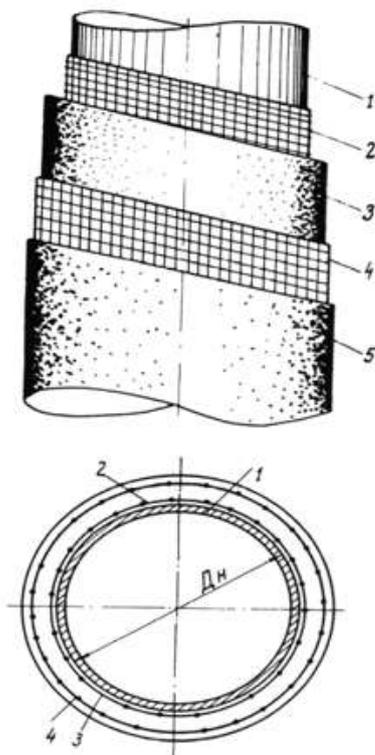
Конструкция монолитного бетонного покрытия:
